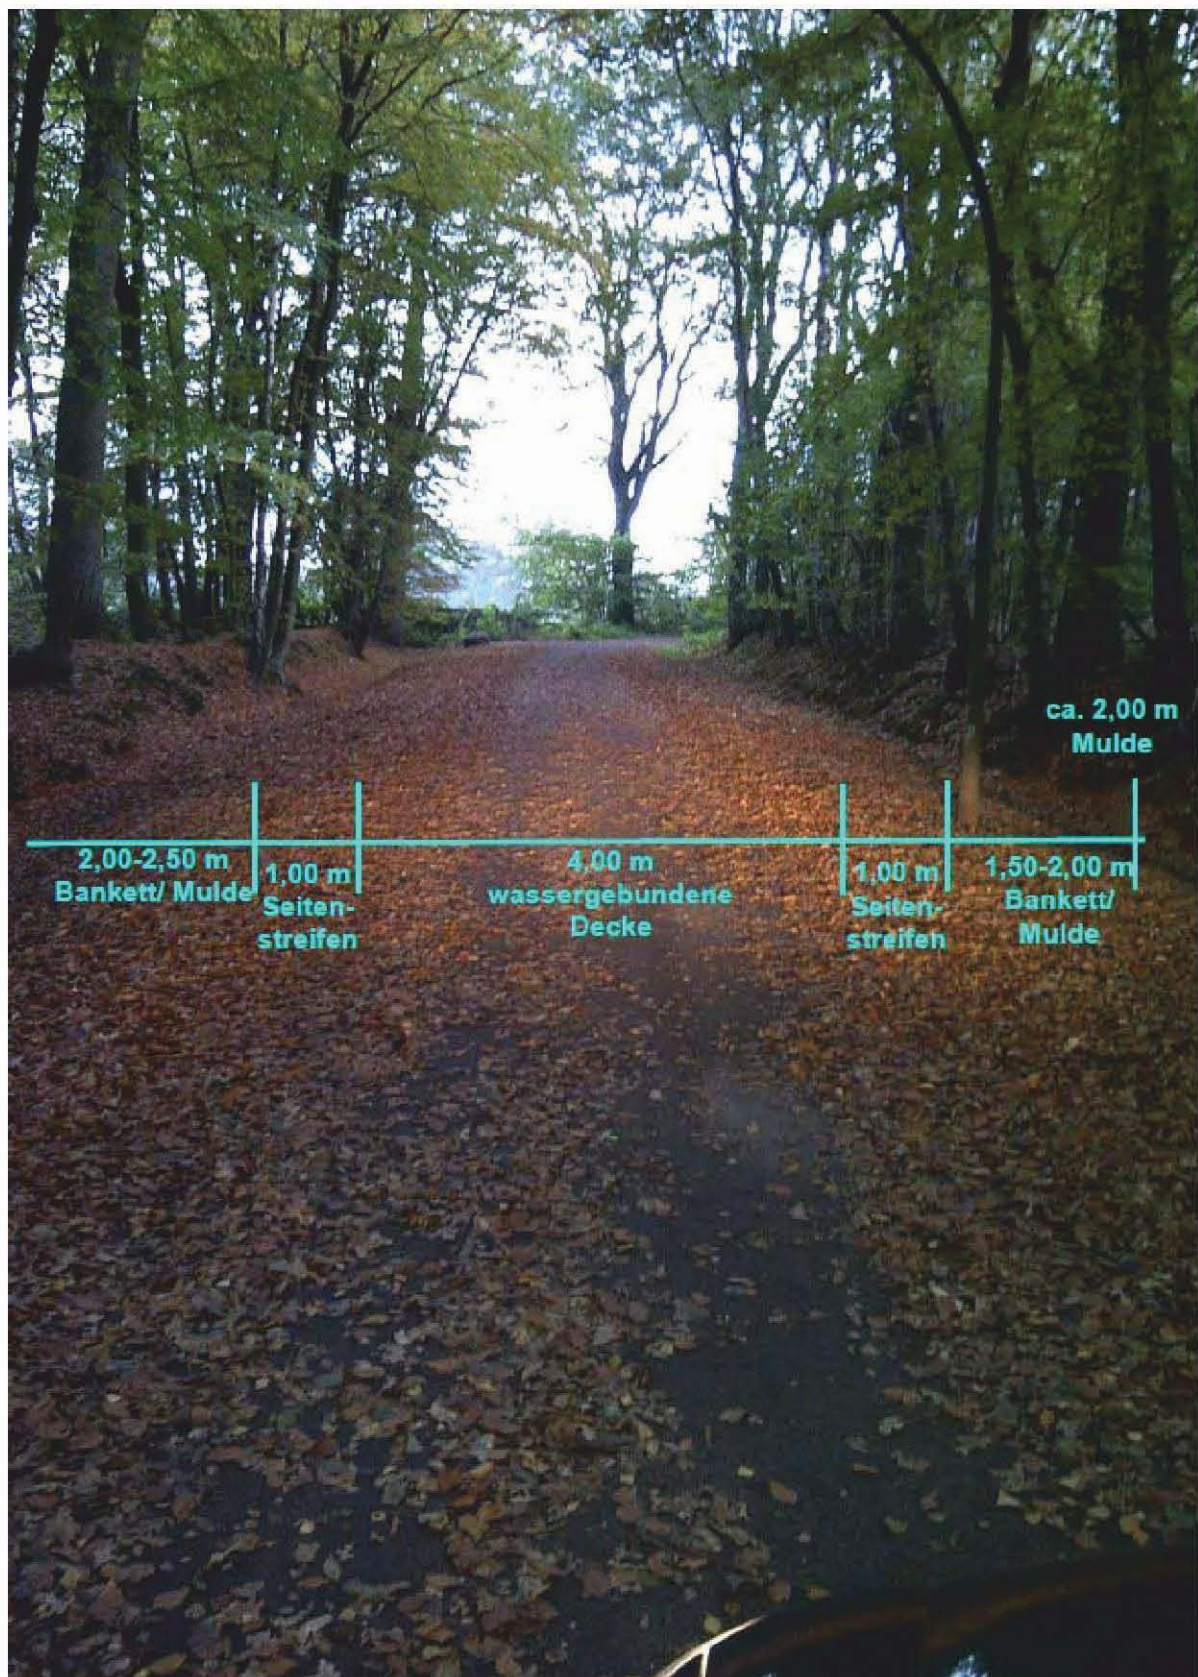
Bestandsaufnahme Bredenbekkamp (nicht asphaltierter Abschnitt West)
